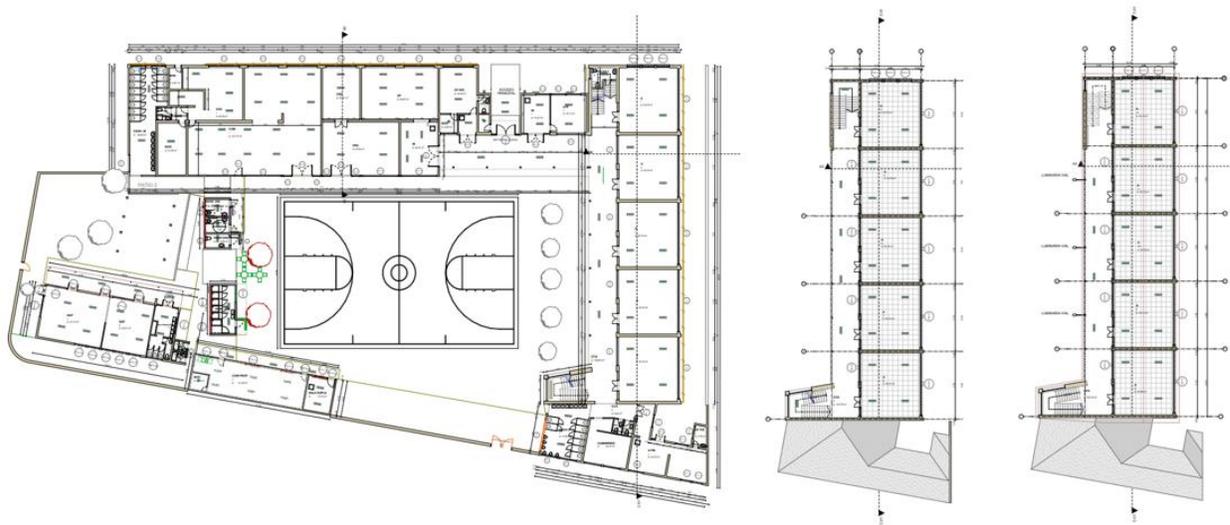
Planos en planta del centro educacional, 1, 2 y 3 nivel.
